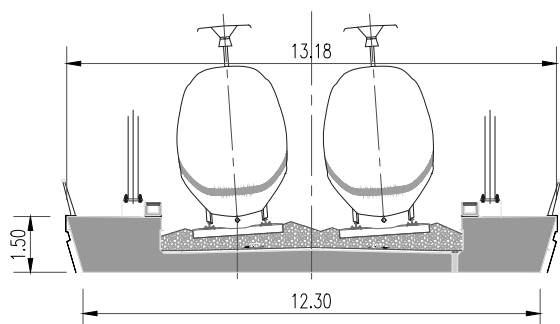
Pont Ain Houalla e Pont de la Tour Mohammed VI: Secções transversais tipo. Pont Ain Houalla and Pont de la Tour Mohammed VI: Deck cross-sections.
